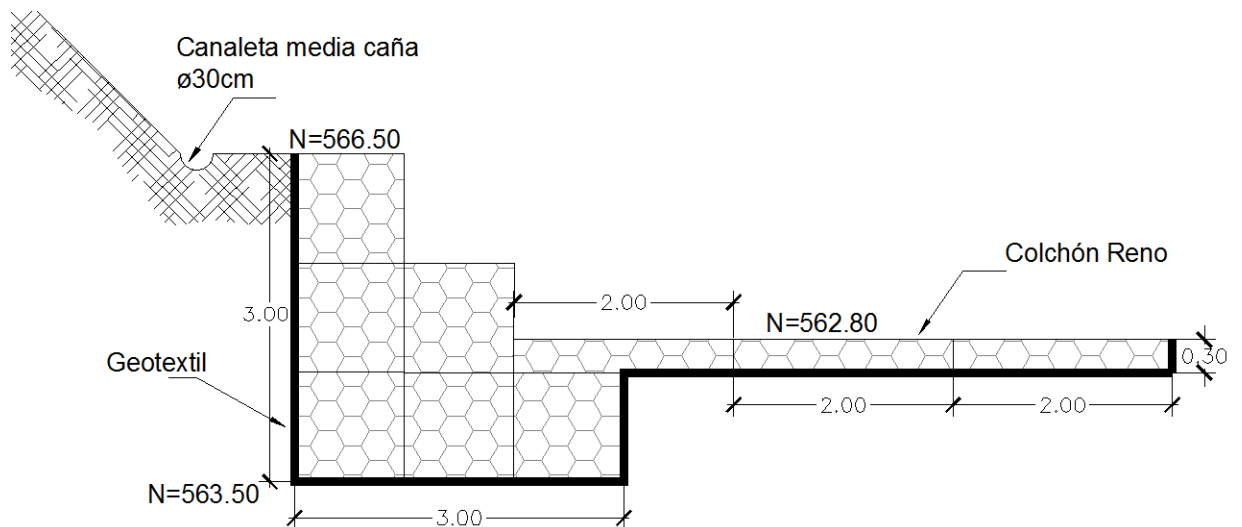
Detalle del Muro Gavión de la Alternativa N°3.
